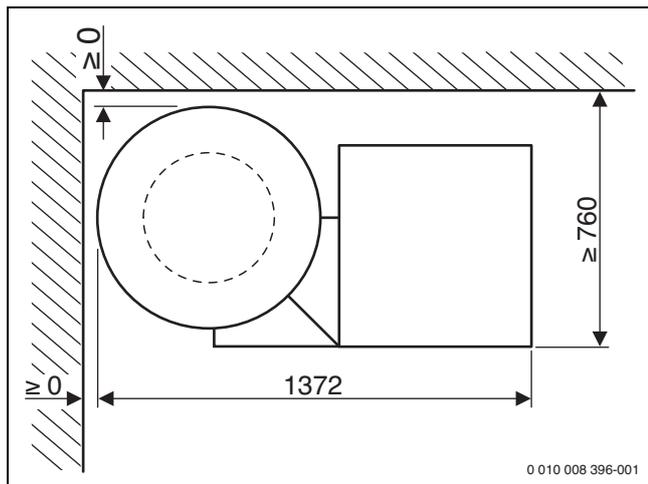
Dimensioni con l'accessorio accumulatore puffer PNR400 (dimensioni in mm)
